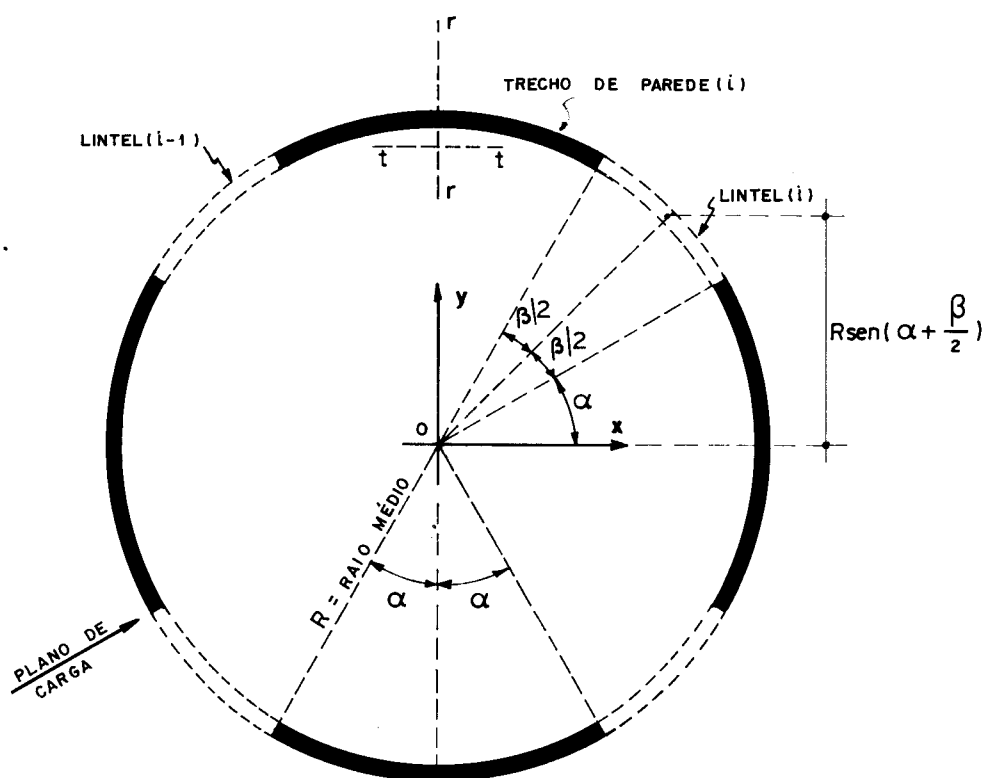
NÚCLEO CENTRAL EM PLANTA
